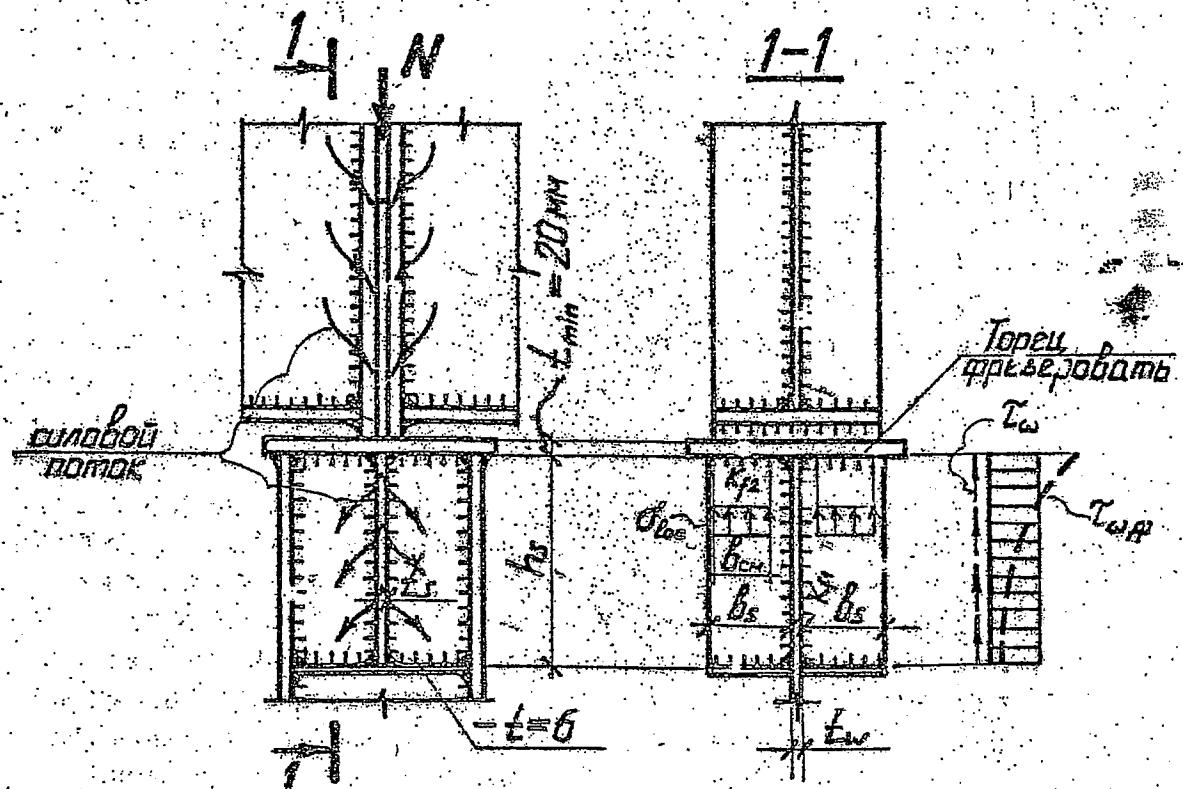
К расчету и конструированию столовка стыково-сплошнотрубной колонны
